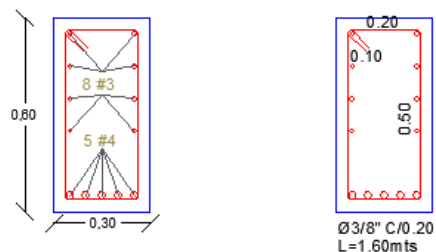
Sección trasversal de las riostras para un puente de concreto reforzado de 12 metros. (ver anexo 02 página 04)
